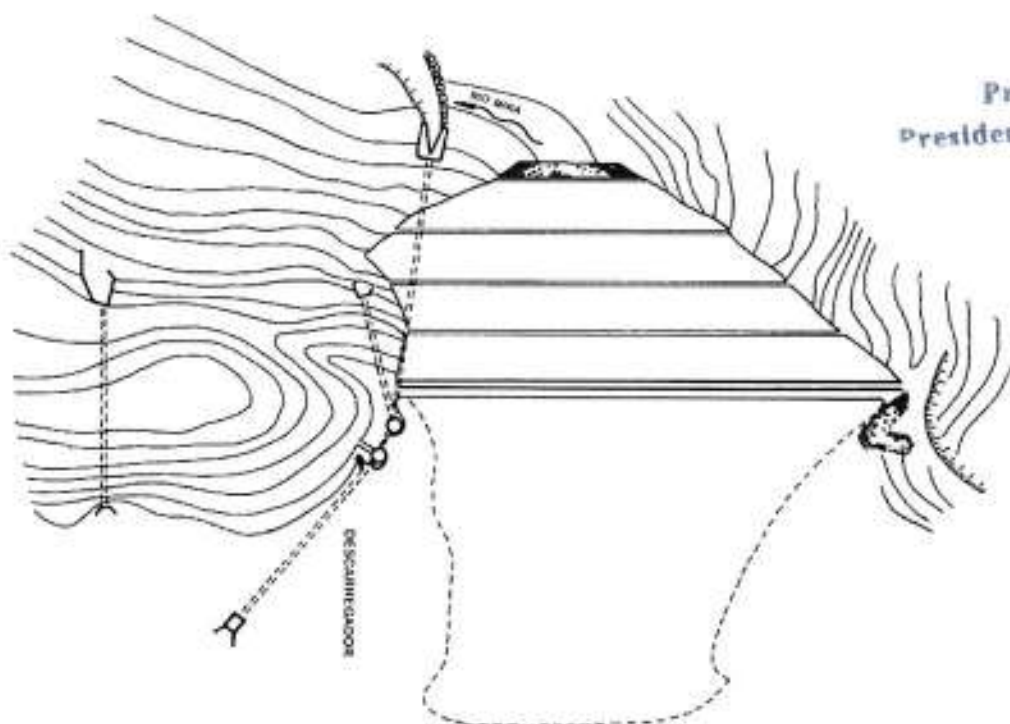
Planta da barragem do Santa Clara (Fonte: portal INAG – Barragens de Portugal)
